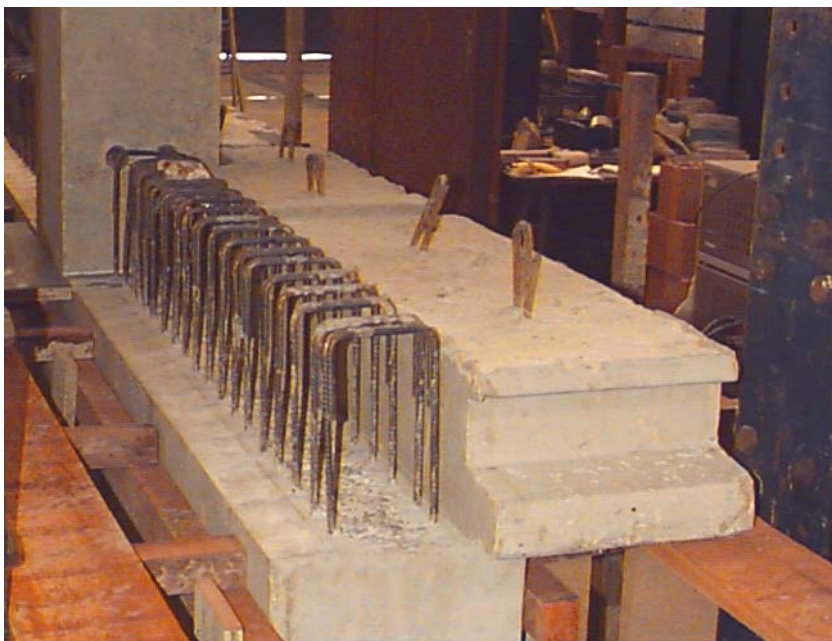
Posicionamento das lajes (modelo 2.1).
